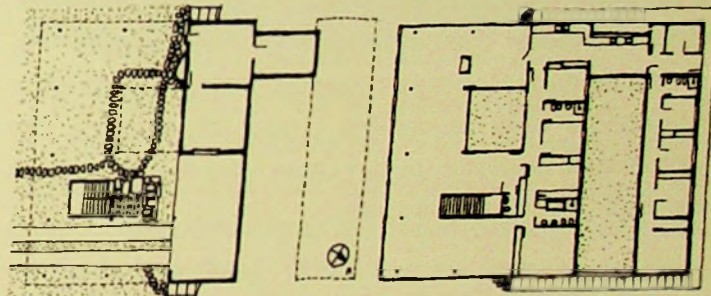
e 805 Croquis plantas pavimento inferior e superior Casa de Vidro.
